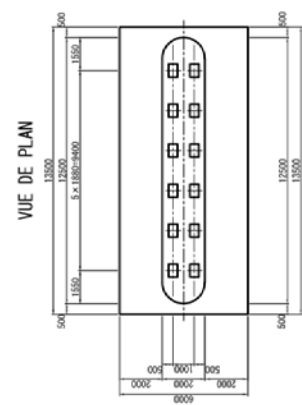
Plan de construction de l'infrastructure du pont sur le fleuve Koumongou (2)
